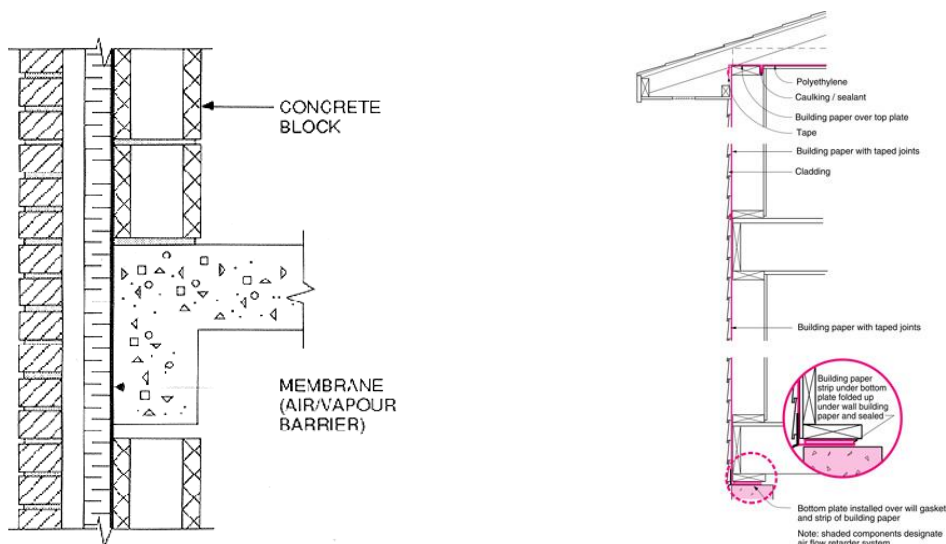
Detalle de estanqueidad tipo de distintos sistemas constructivos.
